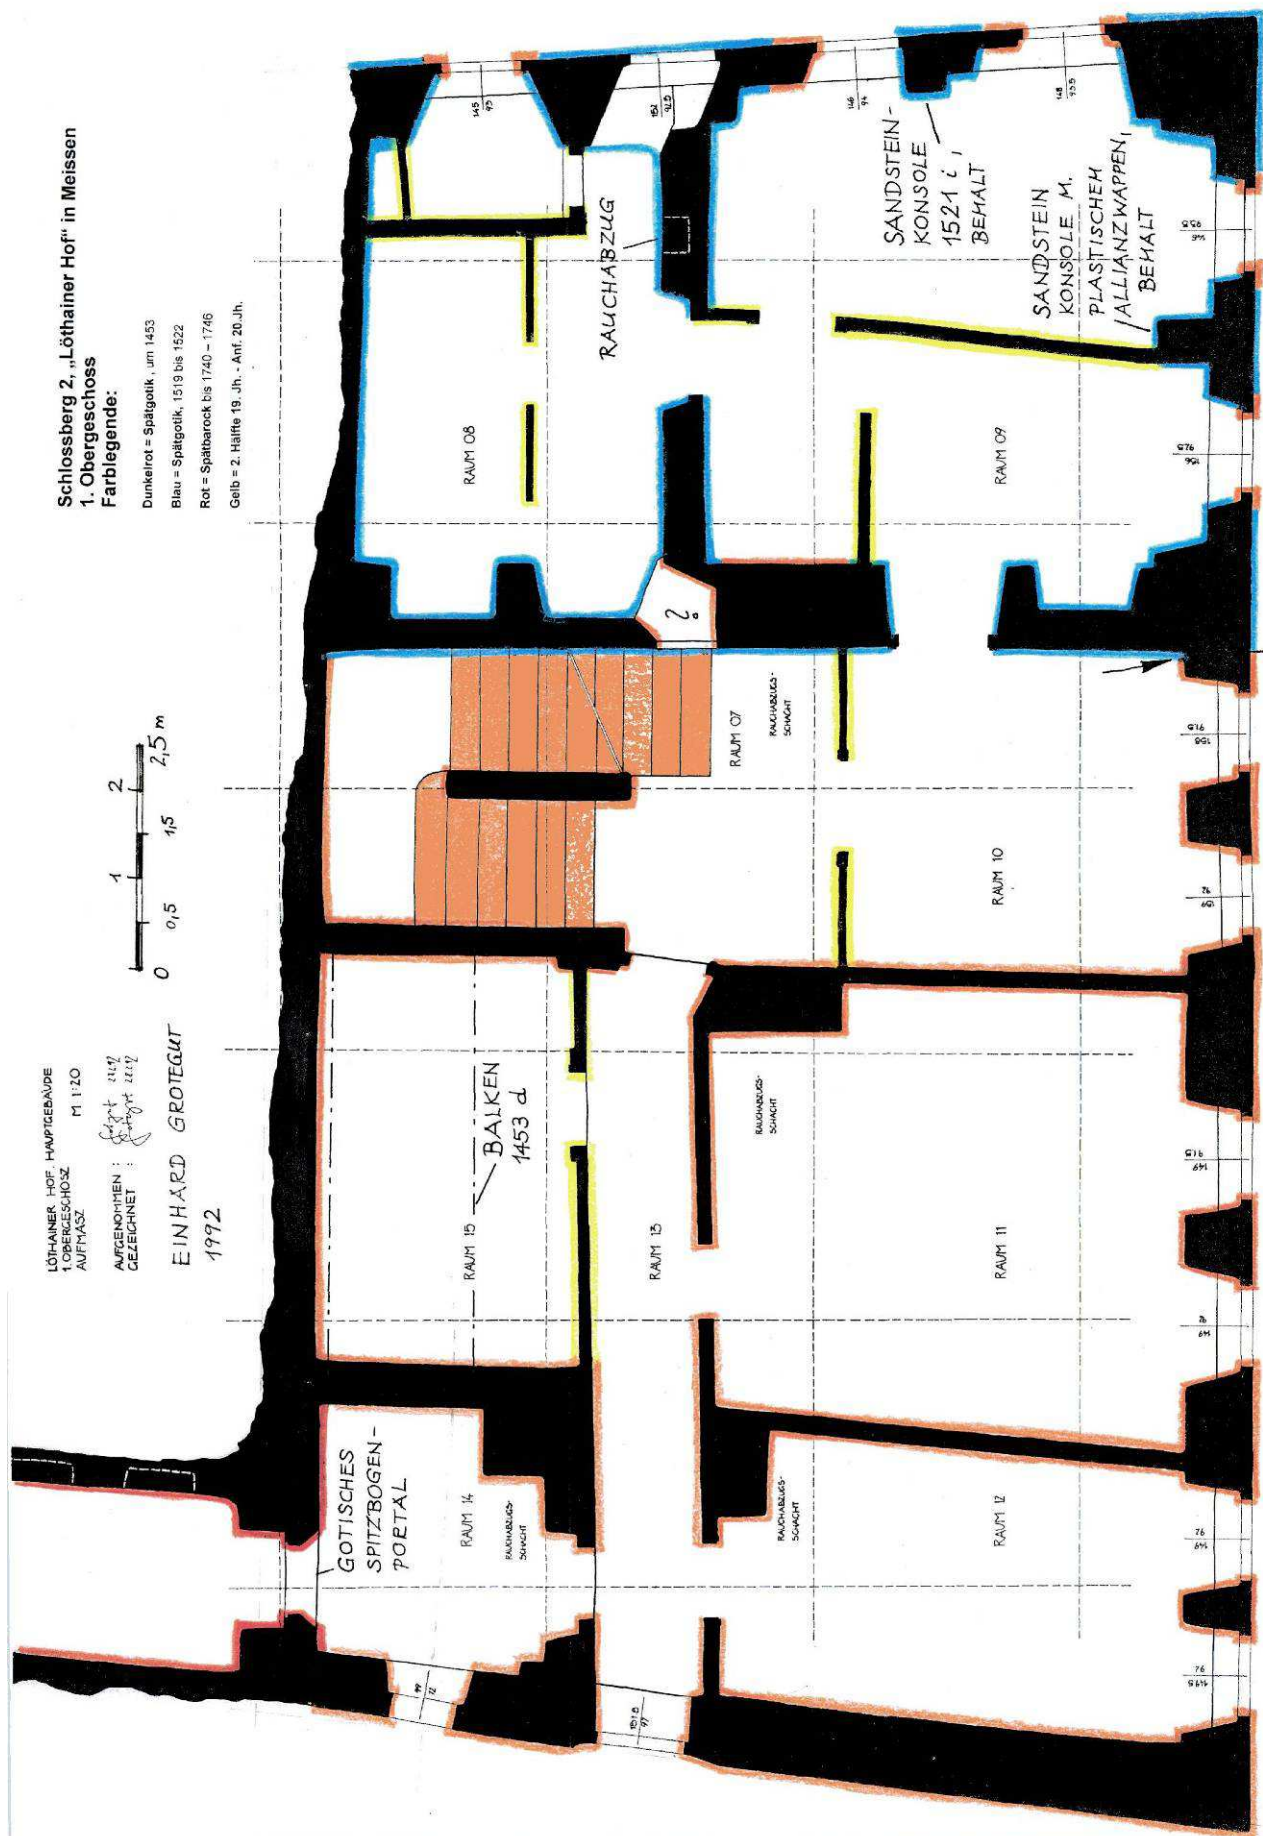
Schlossberg 2, Baualtersplan 1. Obergeschoss
